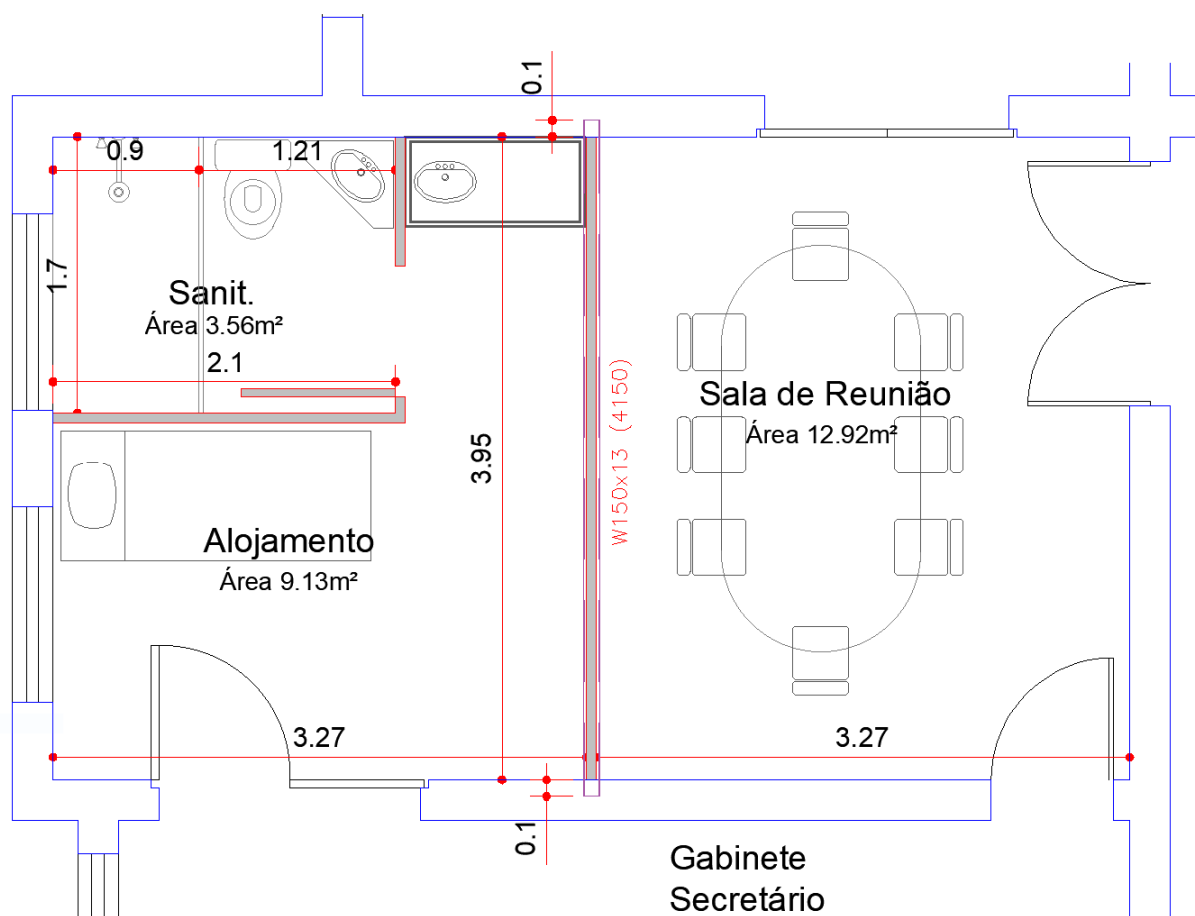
Posição em planta do perfil laminado metálico W150x13, embutido nas paredes de tijolos maciços (10 cm de cada lado) para adequação da Sala de Reuniões para Alojamento no Gabinete do Secretário. Segundo Projeta da Arquiteta Andresa Barbosa Carmo, de abril de 2019
